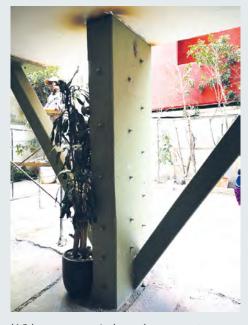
Encamisado de vigas con ángulos y soleras. Fuente: Horse Construction Company China, www.horseen.com
